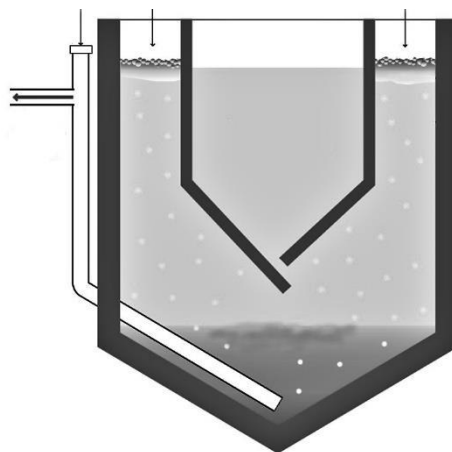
Vista de Corte Frontal de un Tanque Imhoff
